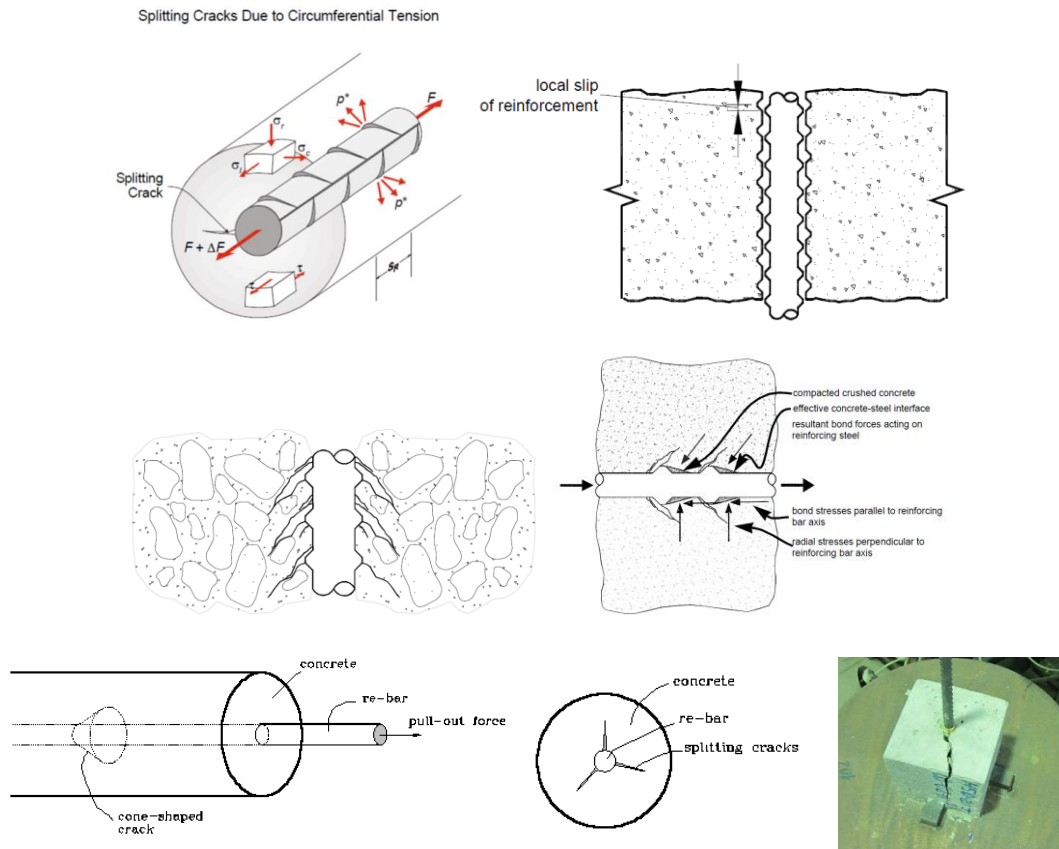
Fisuras longitudinales (splitting cracks)
